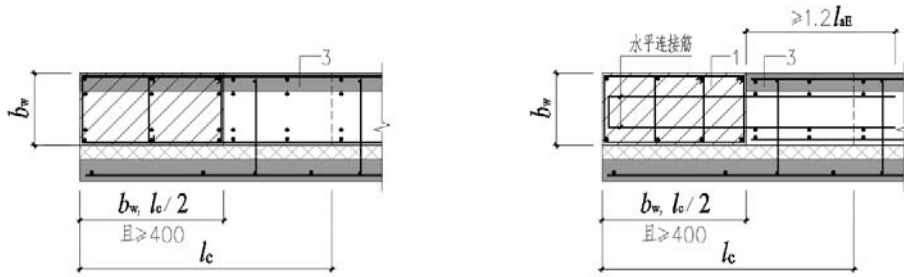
约束边缘构件阴影区域全部采用后浇混凝土的构造示意
